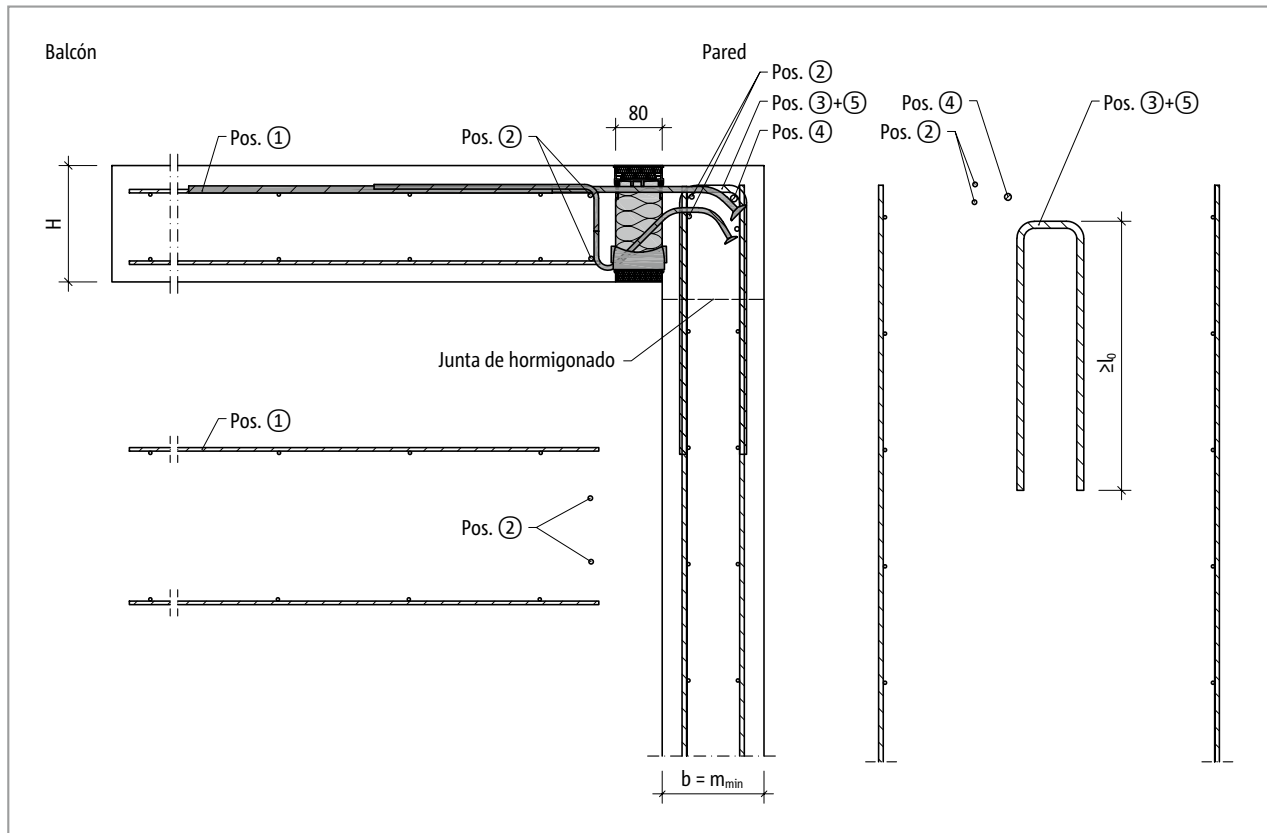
Schöck Isokorb® T tipo K-O: Armadura in situ para conexión a pared hacia abajo con dimensión mínima del elemento constructivo ($m_{exist} = m_{min}$)
